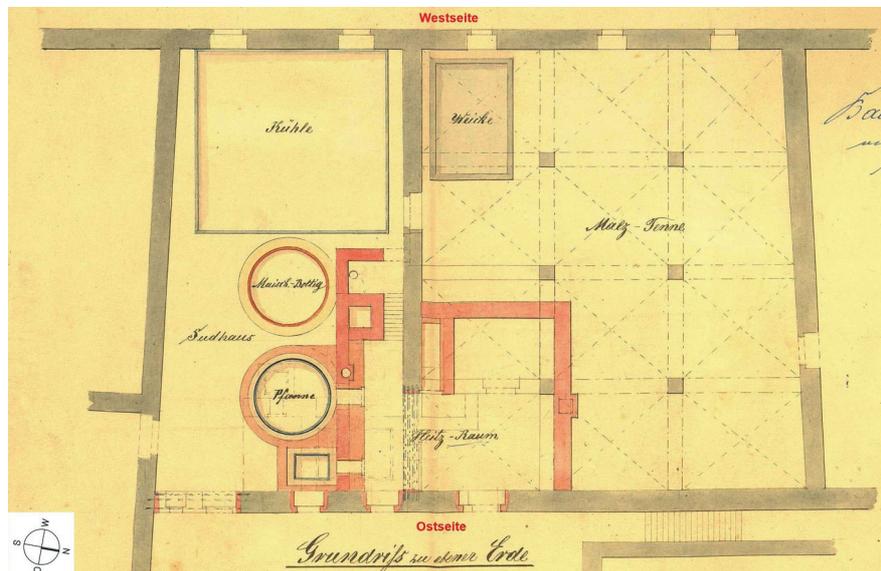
KG-Grundriss für den Umbau der Sudfeuerung und den Einbau der Malz-Darre aus dem StAAm/Bezirksamt Landratsamt Cham, Baugenehmigungsakte 150/1890 (Einbauten sind rot eingefärbt)
